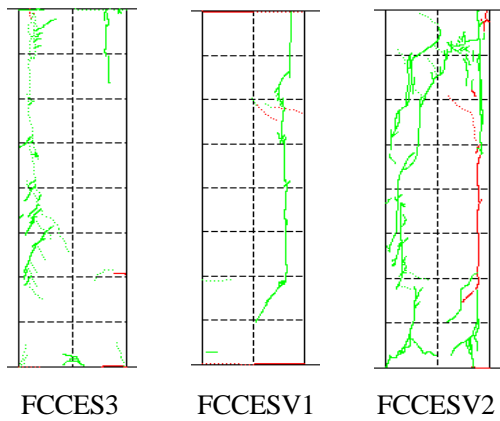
ひび割れ状況 (R=0.01rad.)
